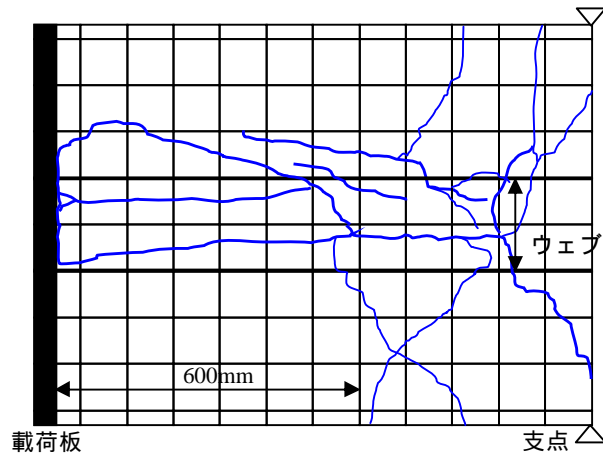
No.2 フランジ上面ひび割れ図 (実験終了時)
